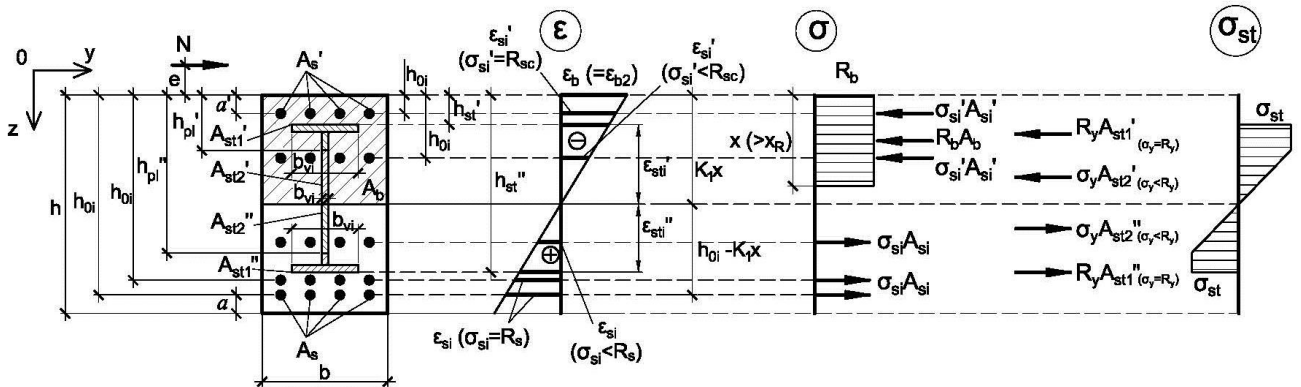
Сжато-изогнутый сталежелезобетонный элемент (с жесткой арматурой) с учетом многорядного расположения арматурных стержней
